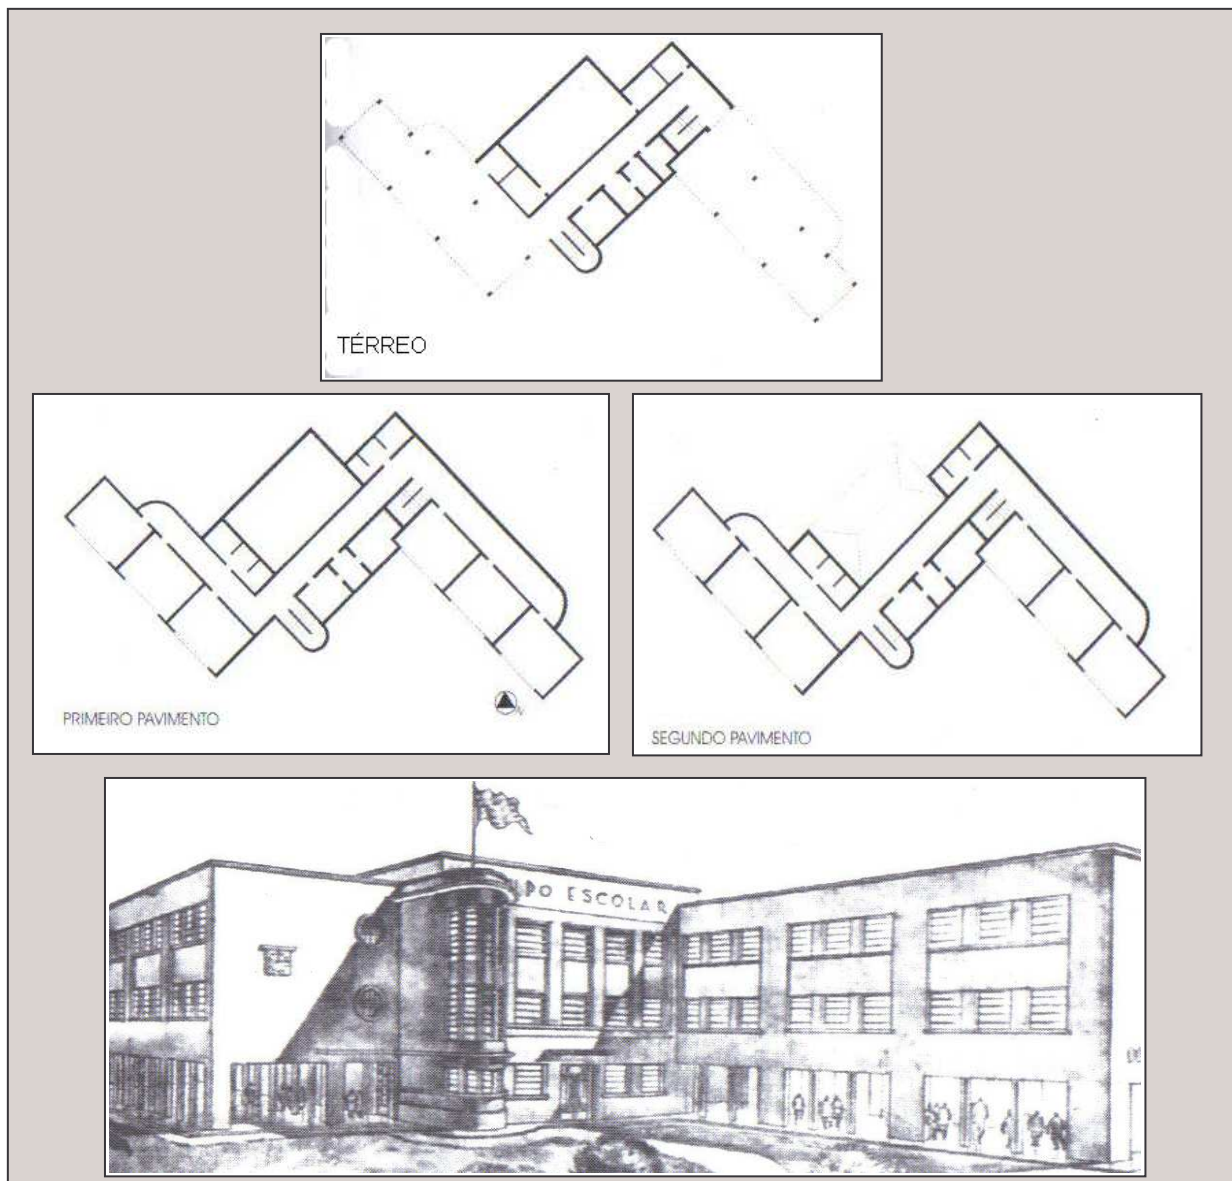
Plantas dos três pavimentos e perspectiva artística da fachada do Grupo Escolar Visconde Congonhas do Campo; autoria de José Maria da Silva Neves (1936).
